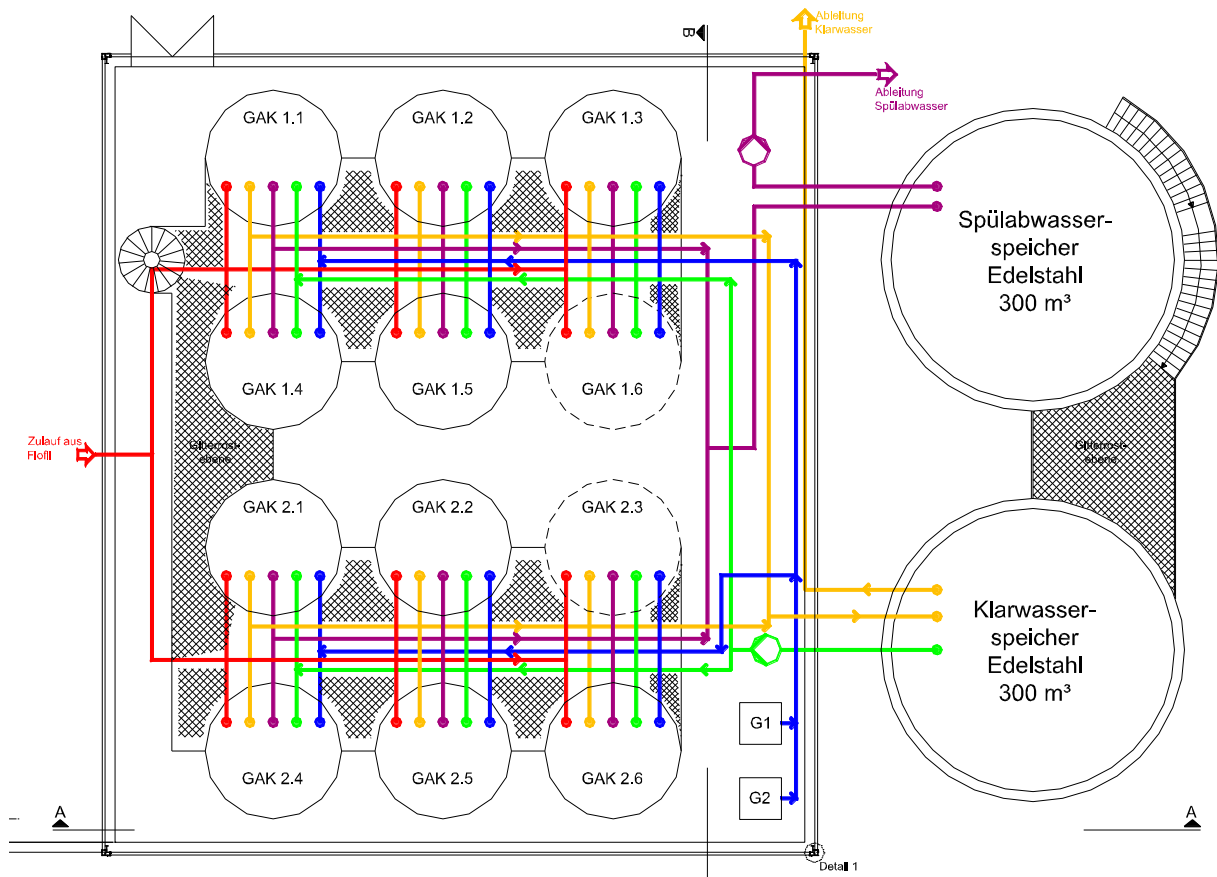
Grundriss der GAK-Halle mit Speicherbehältern
